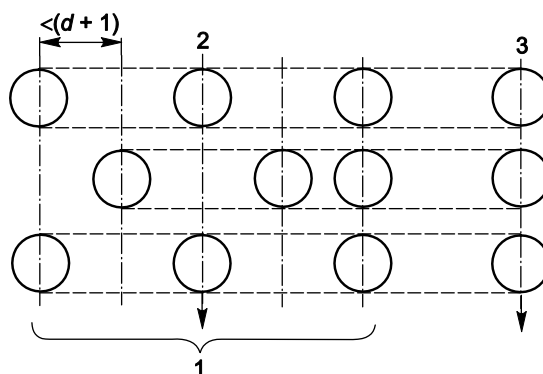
Схема для определения коэффициента  $K_p$  для свай-оболочек или свай-столбов, расположенных в шахматном порядке
